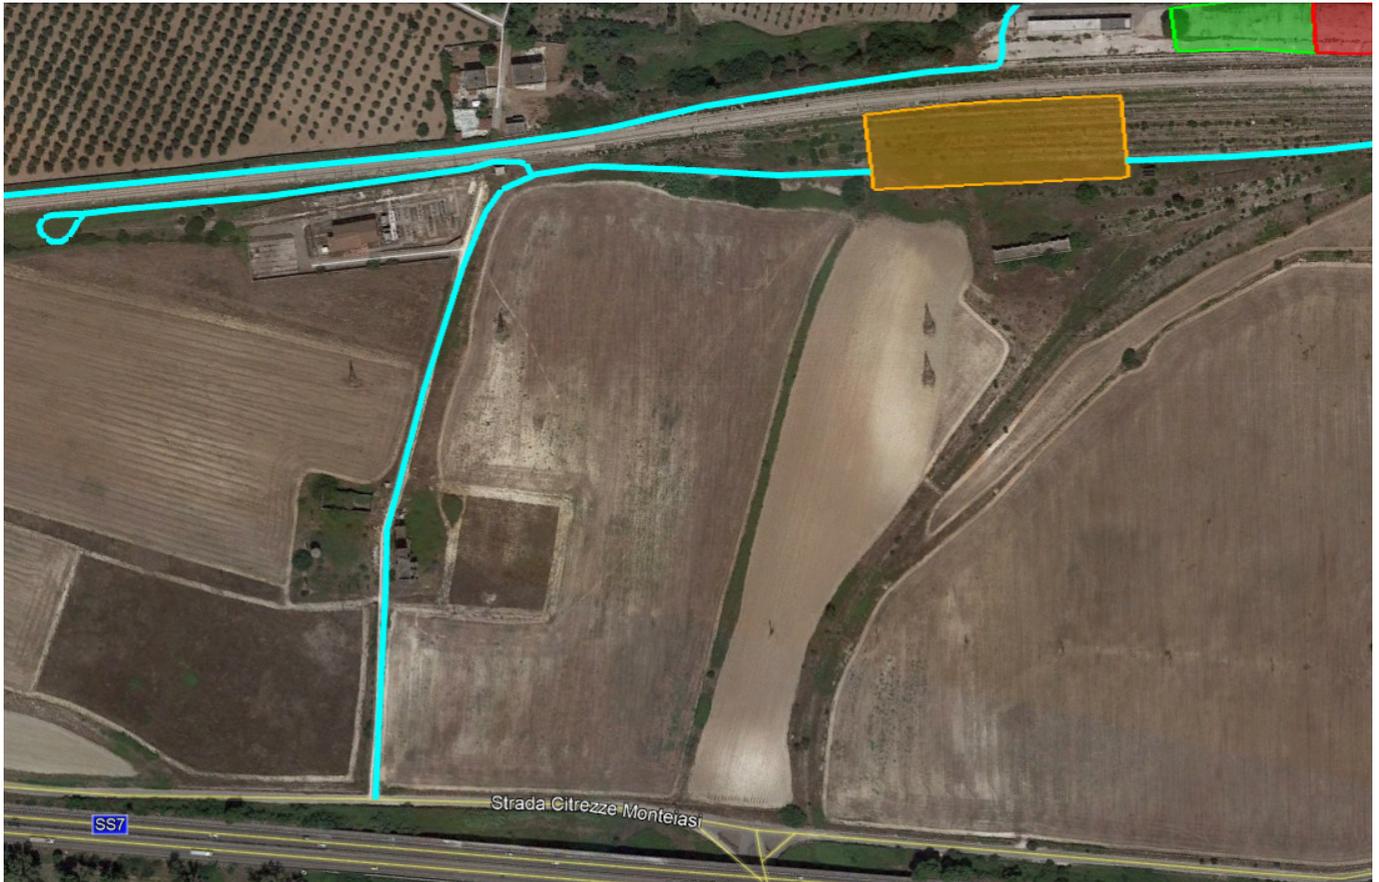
Viabilità utilizzata come pista di cantiere con immissione sulla St. Citrezze Monteiasi
